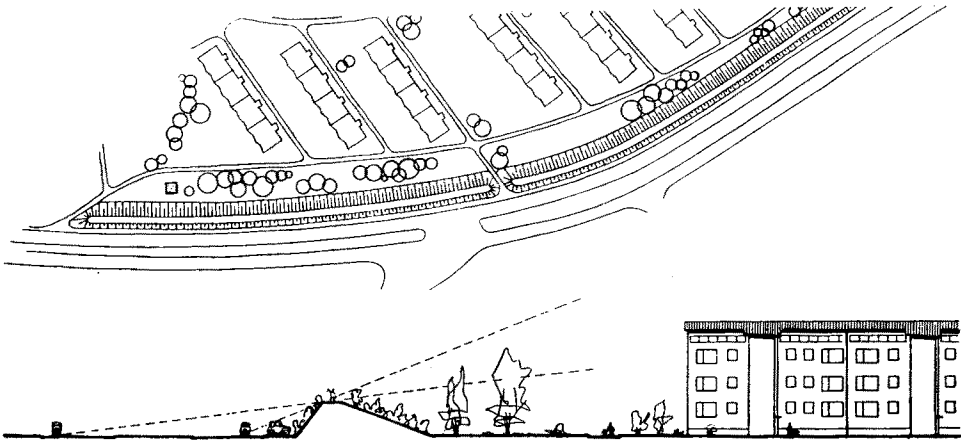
Lärmschutzwall an der Ausfallstraße nach Rothenburg
